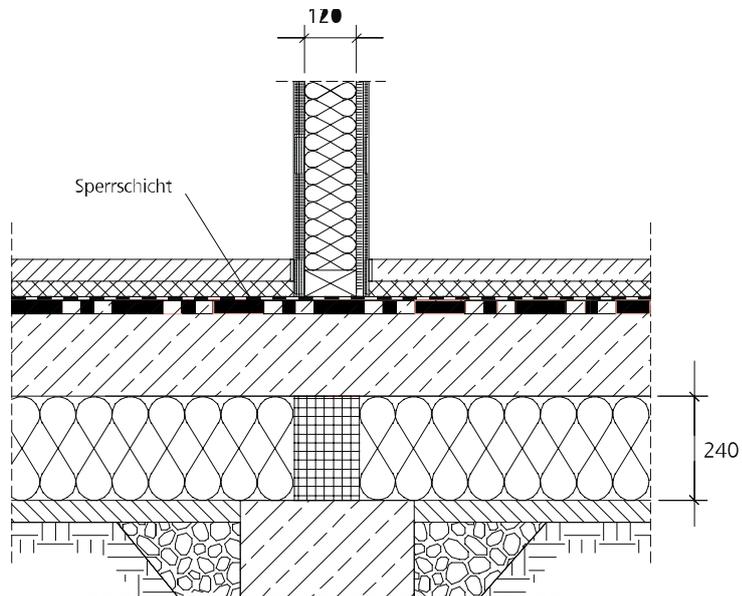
Tragende Innenwand mit Streifenfundament bei außenliegender Dämmung. Über dem Fundament angeordnet ist ein druckstabiler Dämmblock zur Lastabtragung. Die luftdichte Ebene ist die Betondecke. Bemessung der Bodenplatte und der Fundamente gemäß Statik
